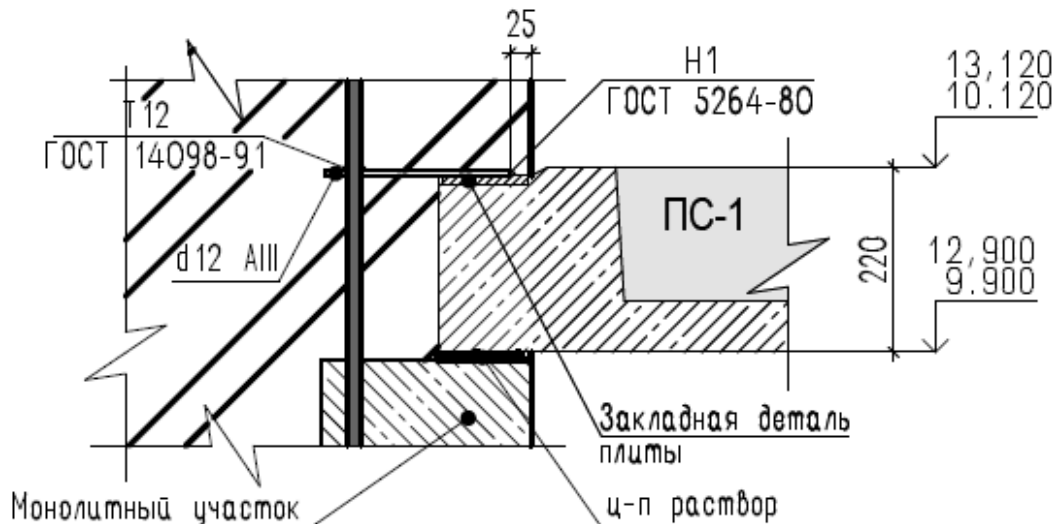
Узел сопряжения сборной плиты перекрытия и кирпичной стены
